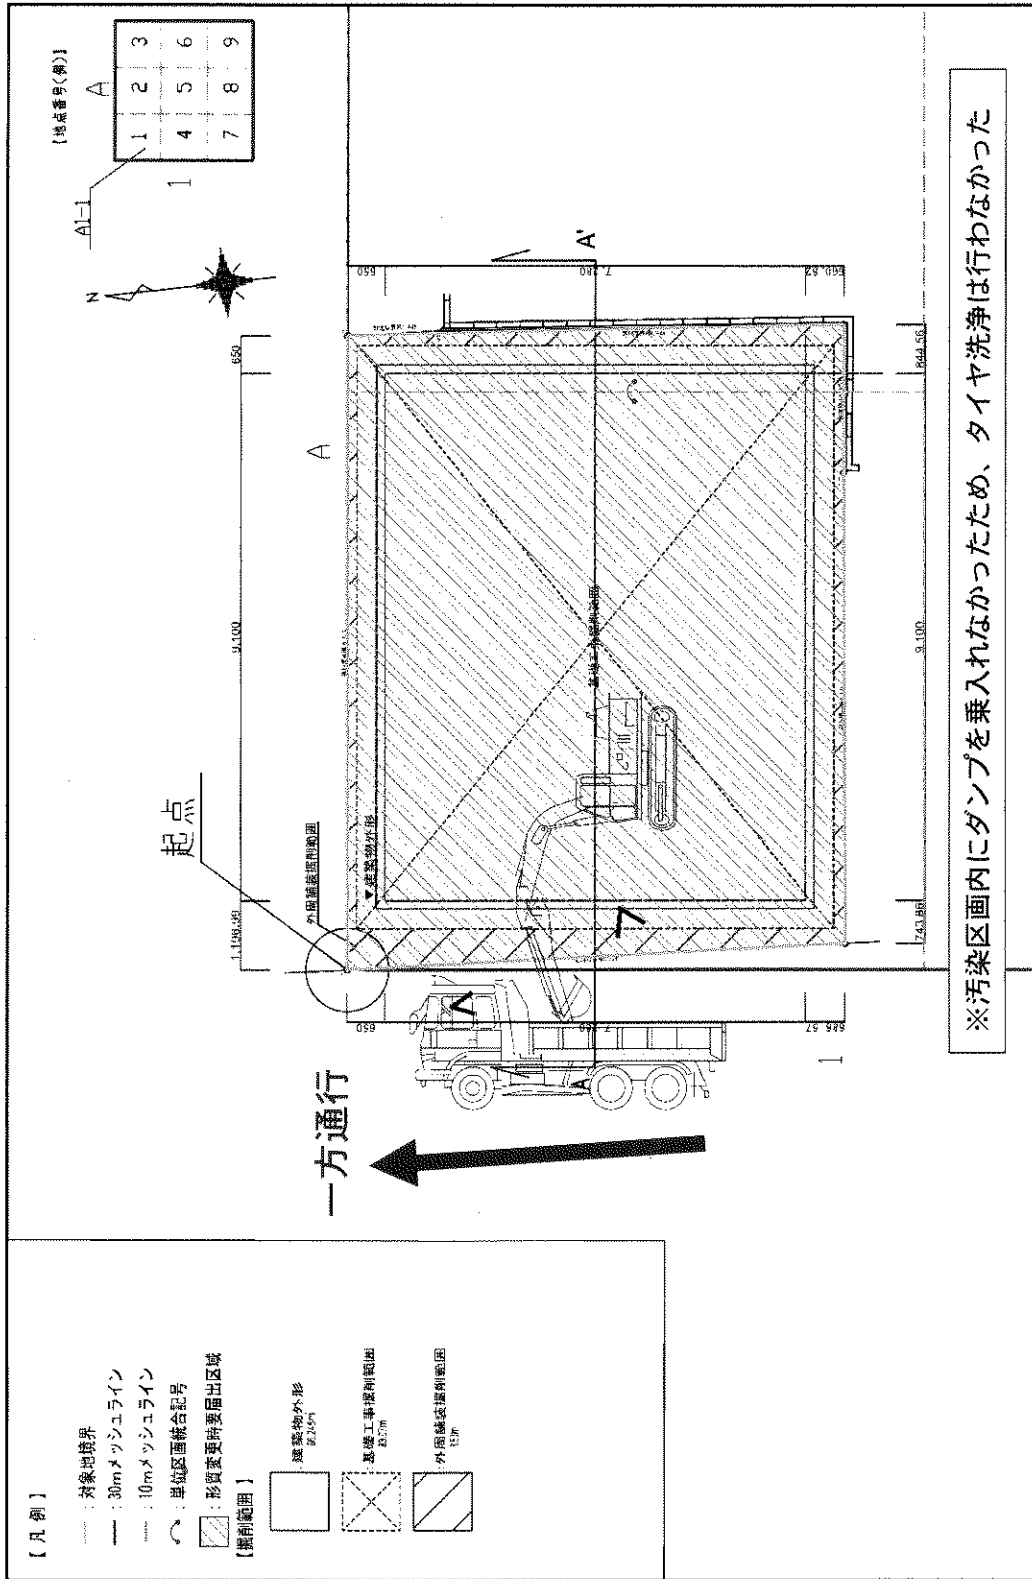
施工方法を明らかにした平面図 (土壌搬出)
